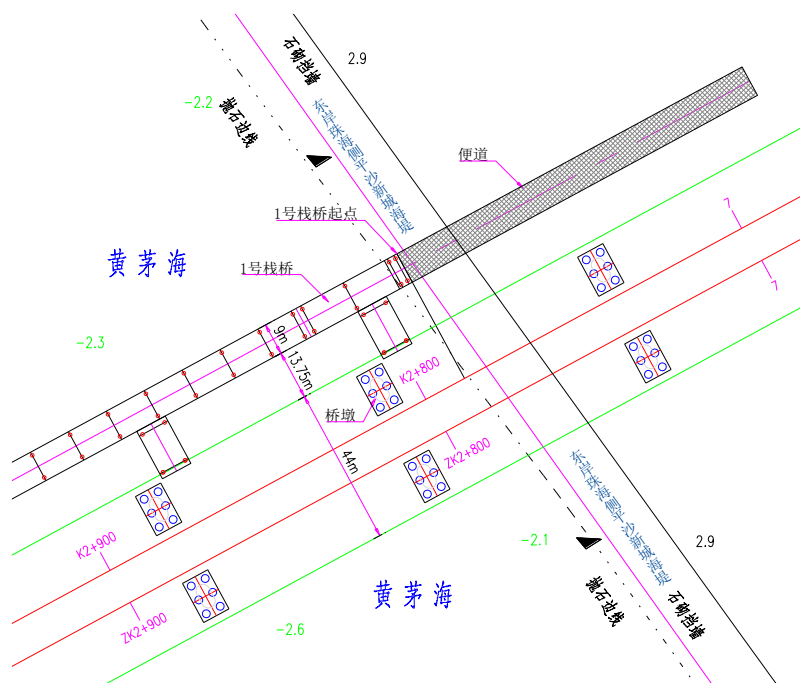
大桥跨越东岸珠海平沙新城海堤平面图（尺寸单位：cm）
